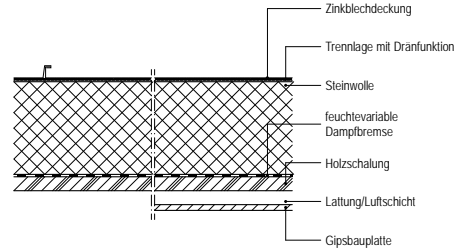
Nicht belüftetes Dach mit nicht belüfteter Dachdeckung, Aufsparrendämmung (Konstruktion 4)
